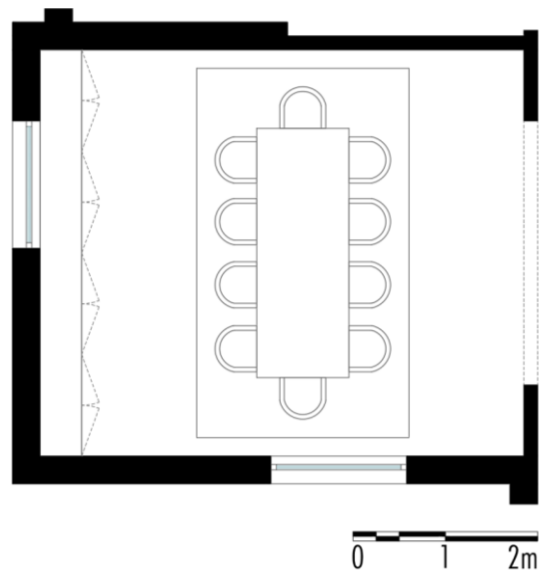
Planta de estudo de *layout* da sala de jantar 2 (Fonte: Autora, 2022)
